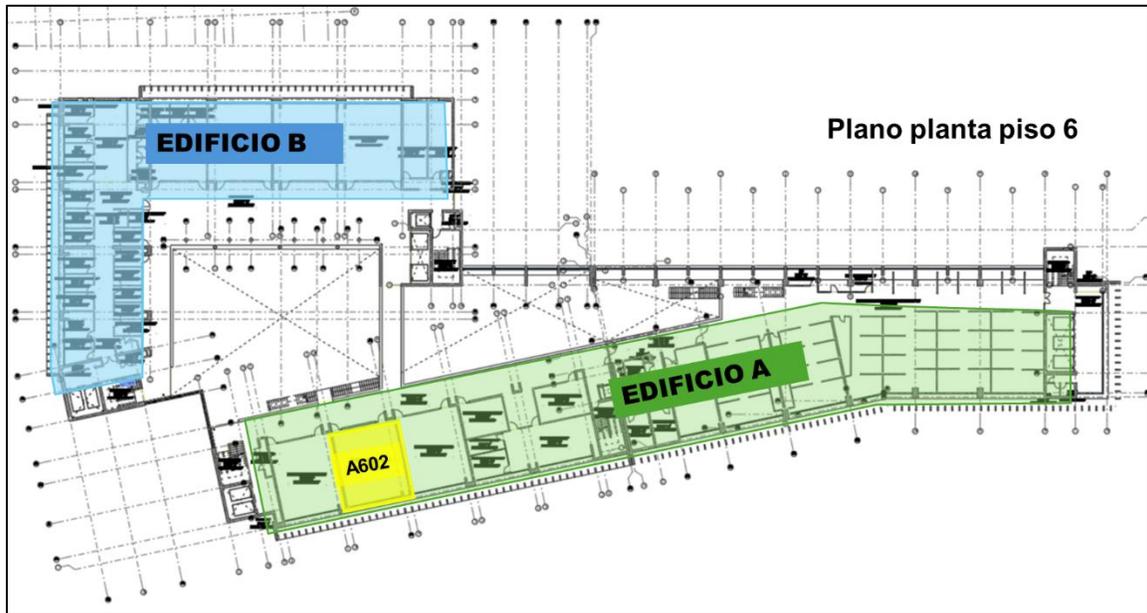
Plano general del piso 6 Sede Bellavista - AutoCAD
